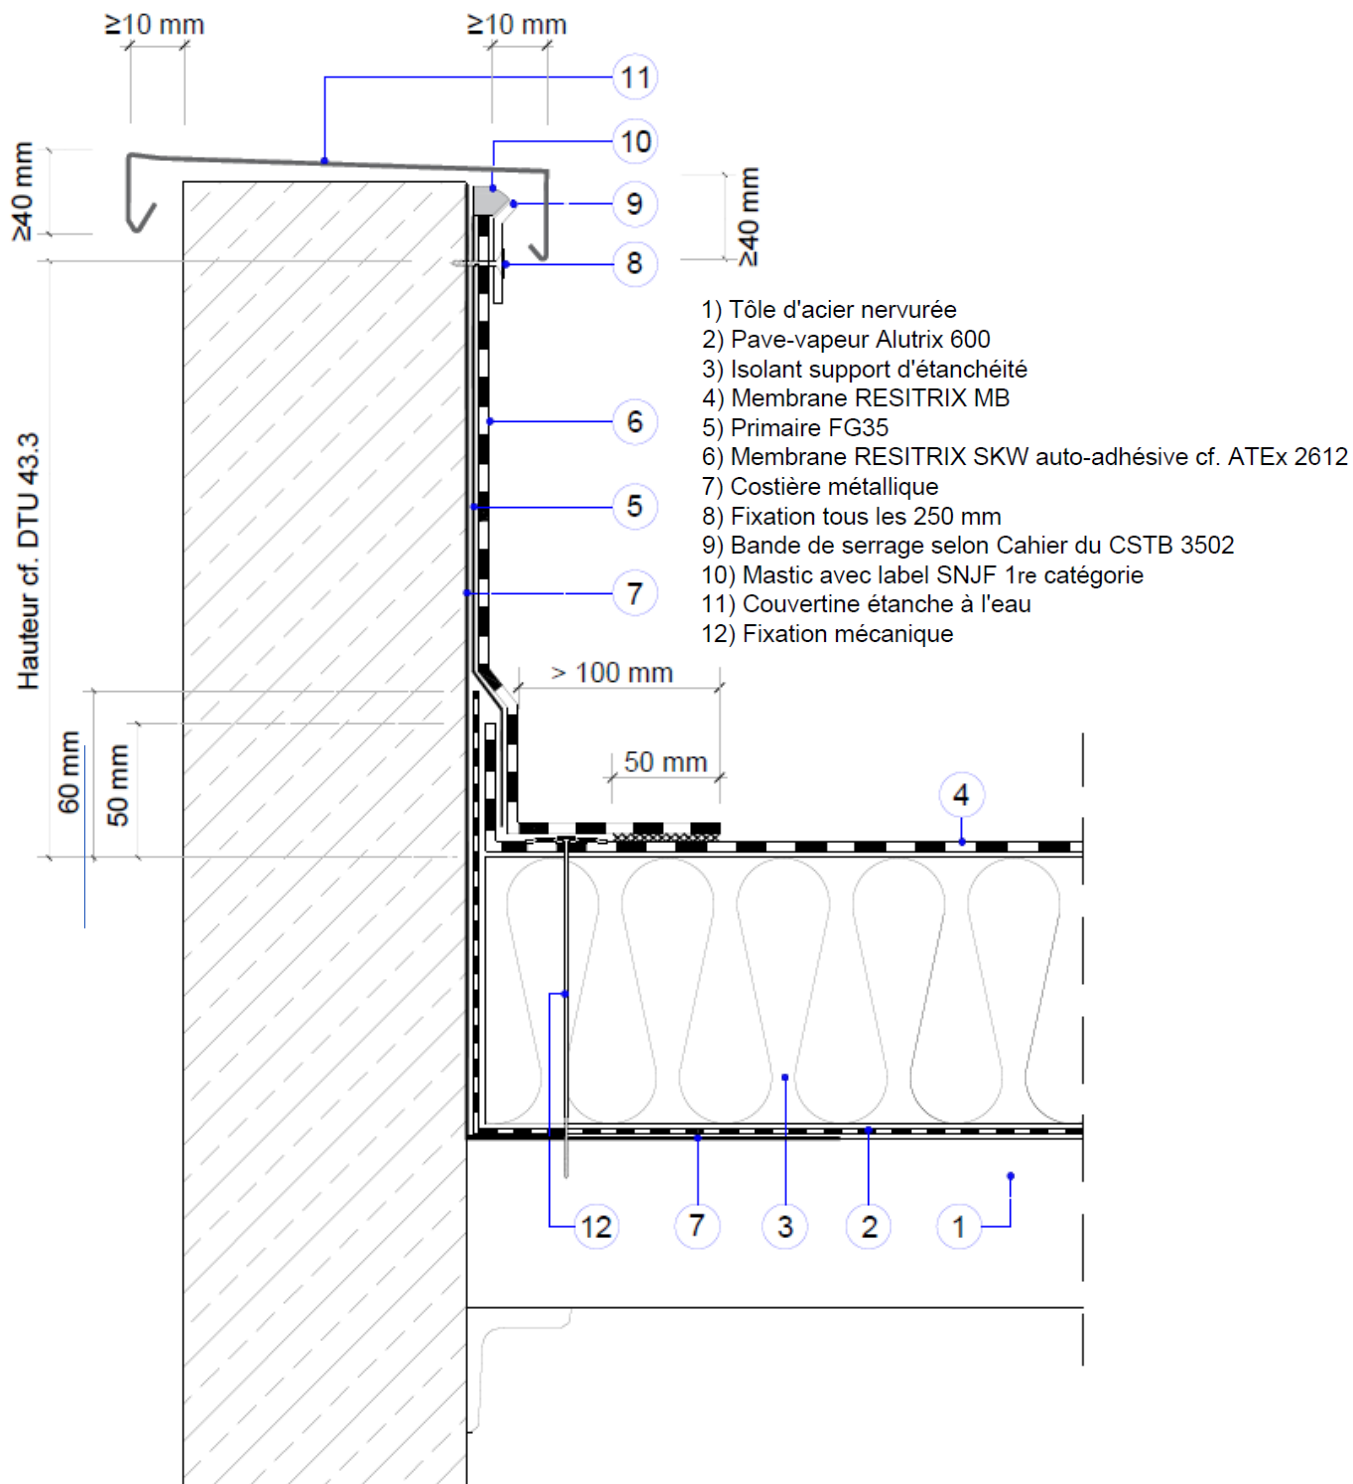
Exemple de relevé sur TAN avec pare-vapeur
